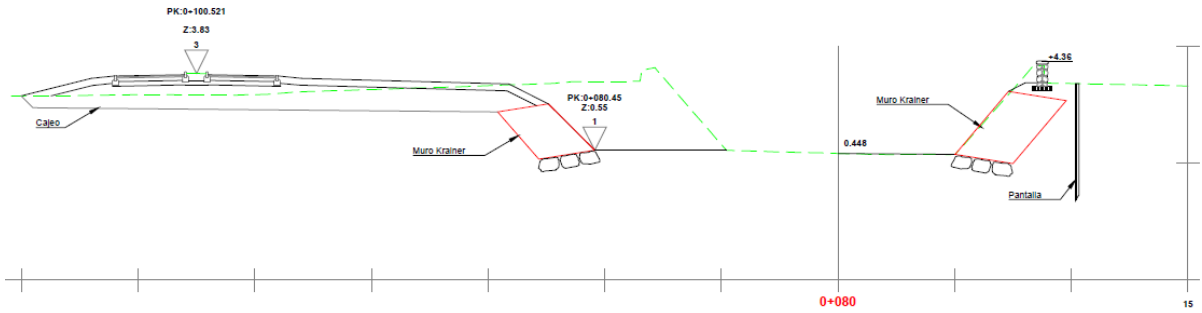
Perfil de las actuaciones propuestas en la zona central del canal.
